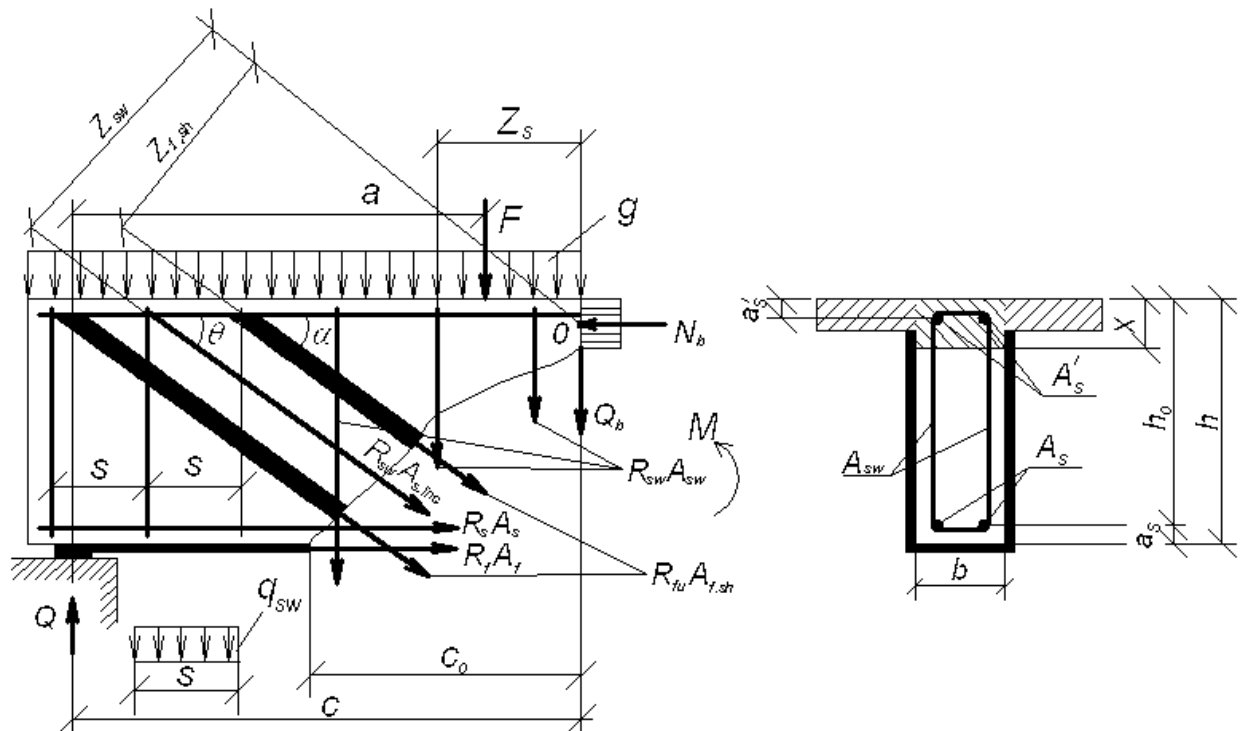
Расчетная схема при расчете наклонного сечения на поперечную силу и изгибающий момент
